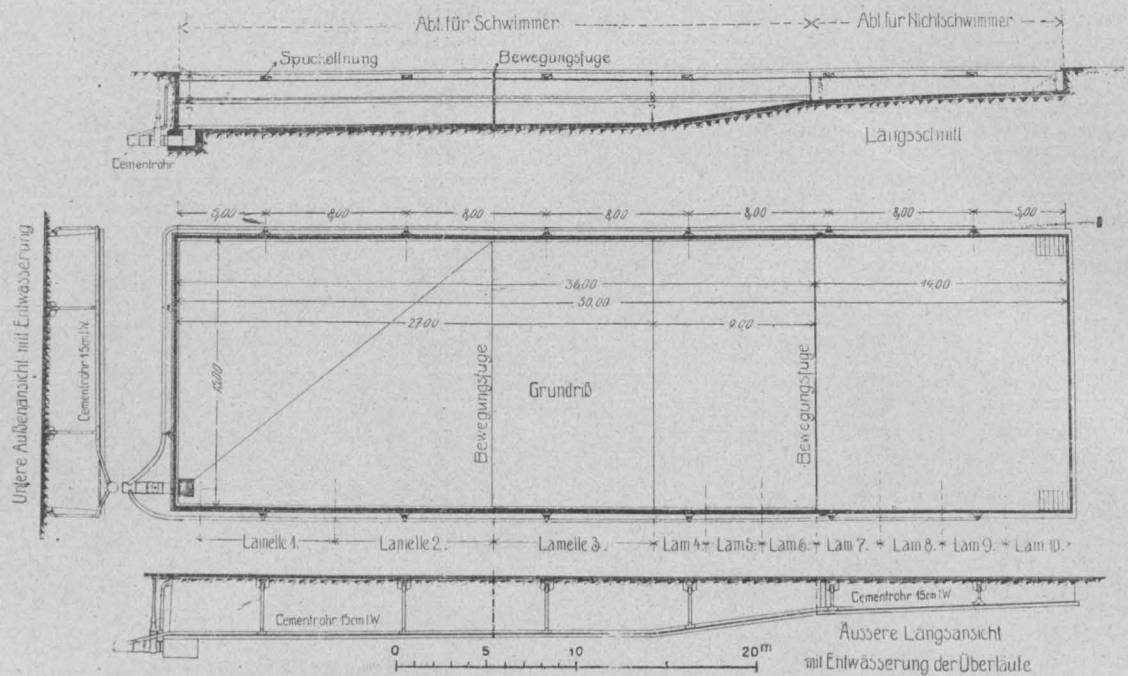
Allgemeine Anordnung des offenen Schwimmbeckens in Eisenbeton.
